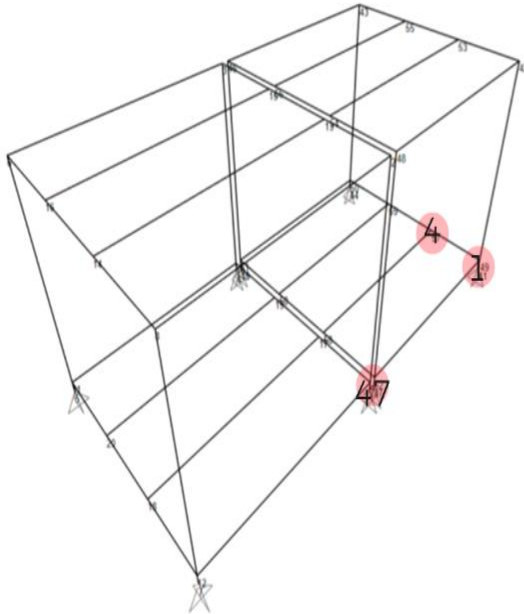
Planta y alzado y el módulo de 3D. Fuente : Elaboración propio.
